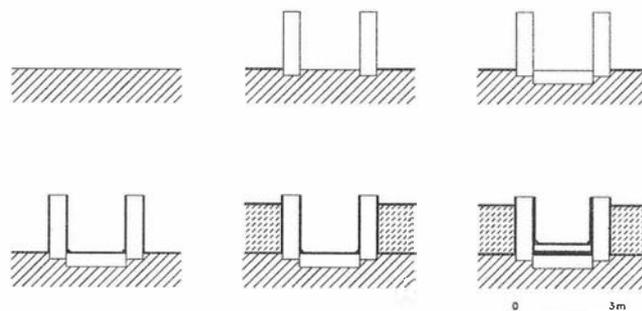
Secuencia constructiva de los estanques situados ante la fachada del palacio.
